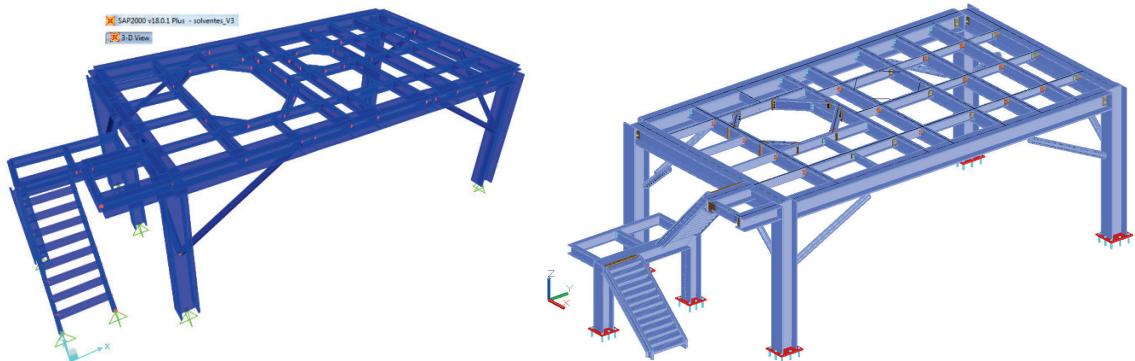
Edificio 1. Propuesta 3D_SAP2000. ZJ. Edificio 1. Edificio para construcción 3D_Prosteel Structures. ZJ.
